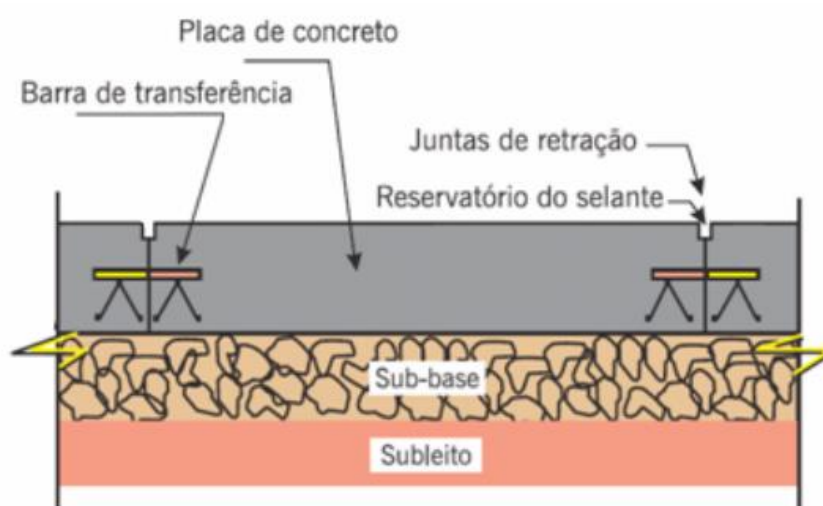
Perfil longitudinal do pavimento rígido (Fonte: Bianchi et Al., 2008).
